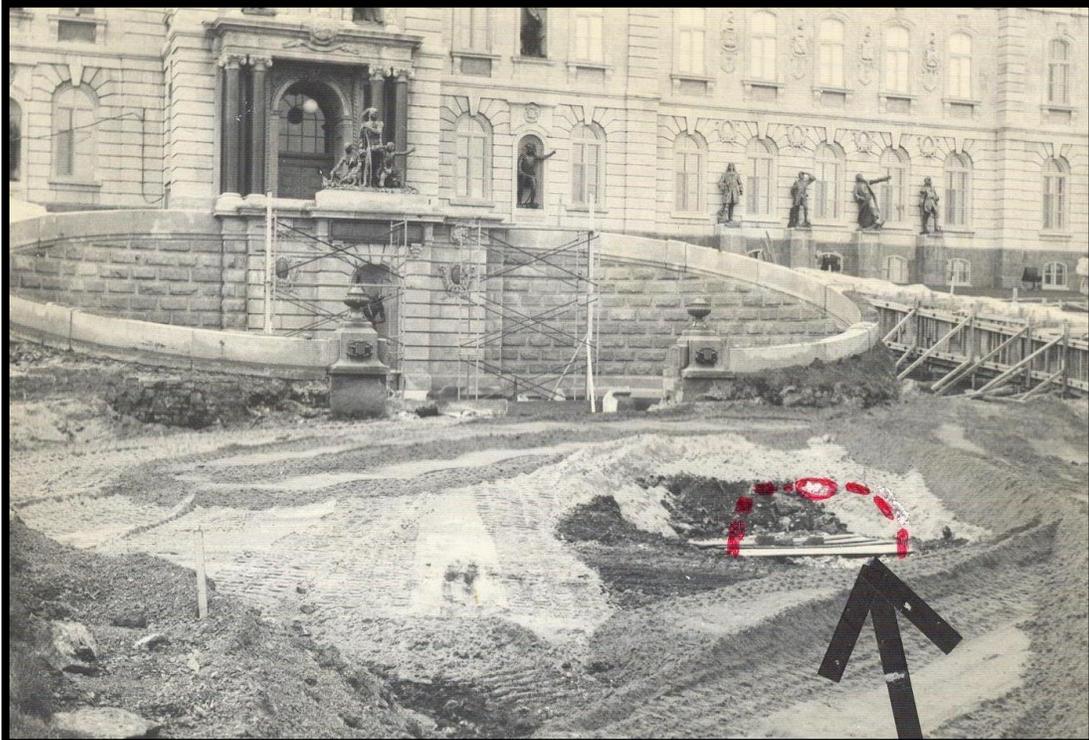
Une fois enlevée la trappe en pierre que l'on voyait en descendant l'escalier du Parlement apparut un trou carré - ici recouvert de planches (*ci-dessous*). Cette trappe donnait sur le faîte de la salle située sous les marches de l'escalier central du Parlement (*photo du haut*).
